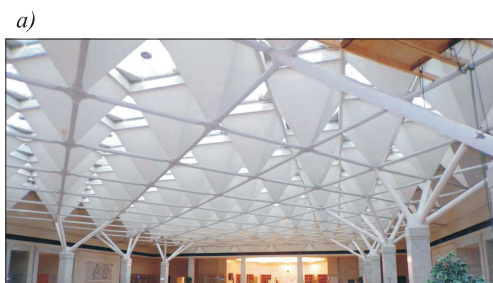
Гибридное структурное покрытие с пирамидальными элементами со сталефибробетонными гранями и железобетонными основаниями, закрепленными к растянутому поясу. Вариант 2
